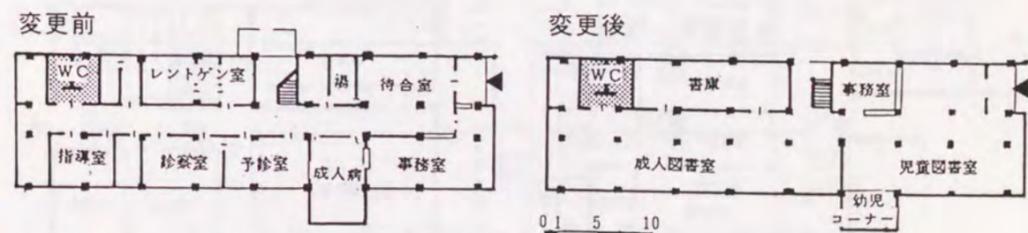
<95>札幌市菊水図書館（旧保健所）1階平面図
